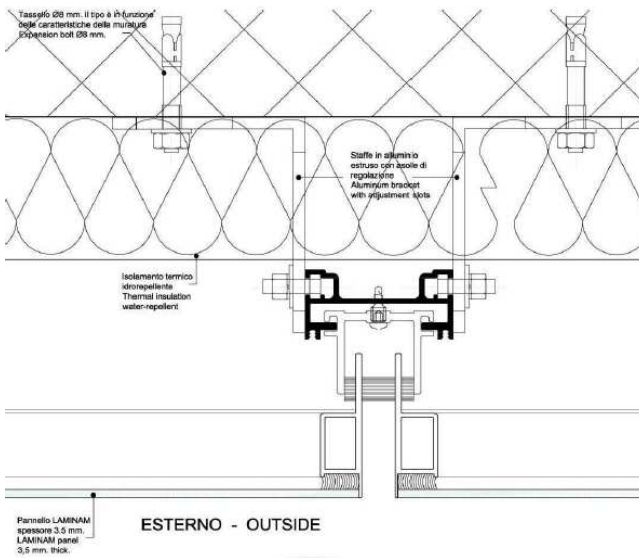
Fachada Laminam - Seção Horizontal: junta intermediária.
